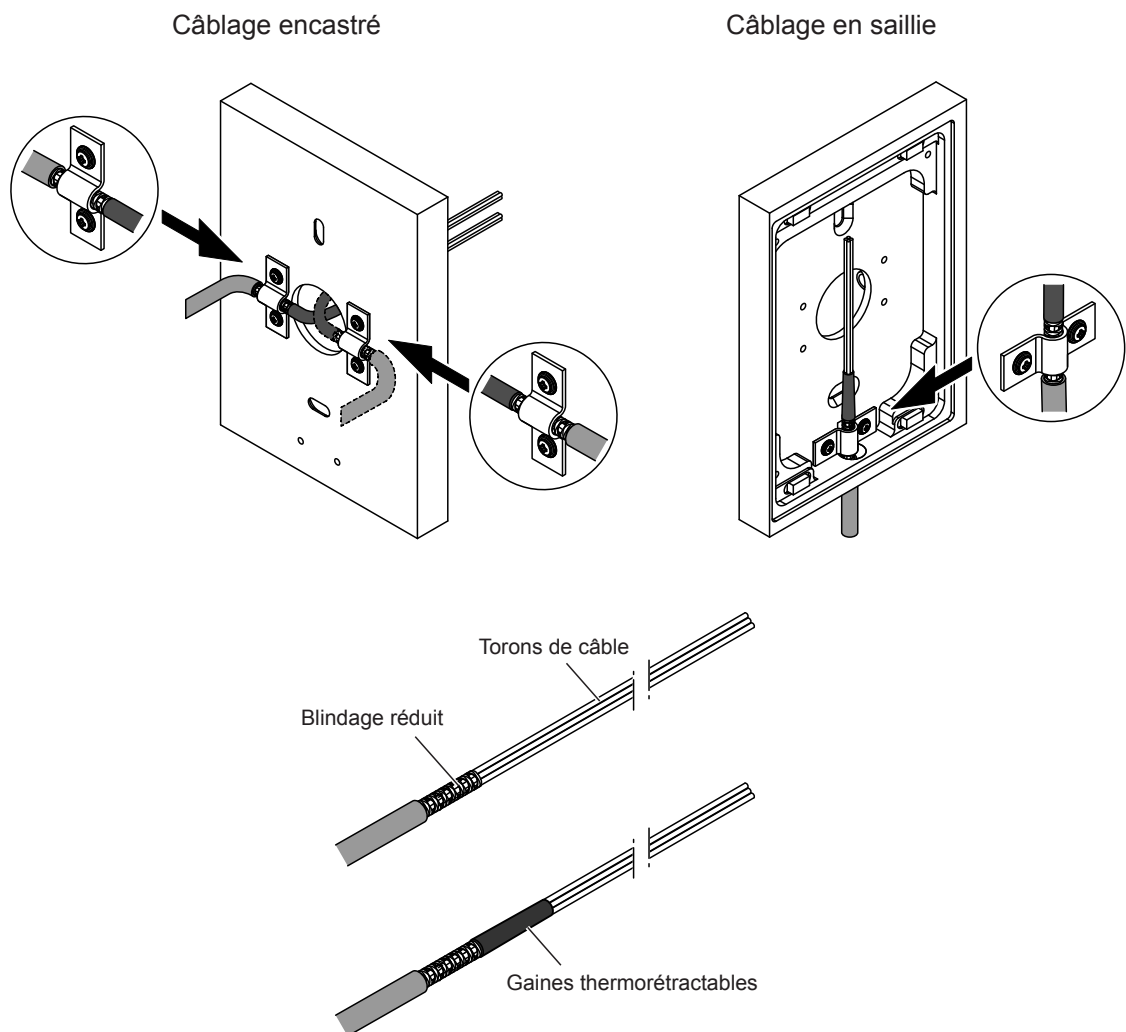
Fixez le câble CAN BUS avec le blindage exposé au boîtier à l'aide des colliers de serrage
